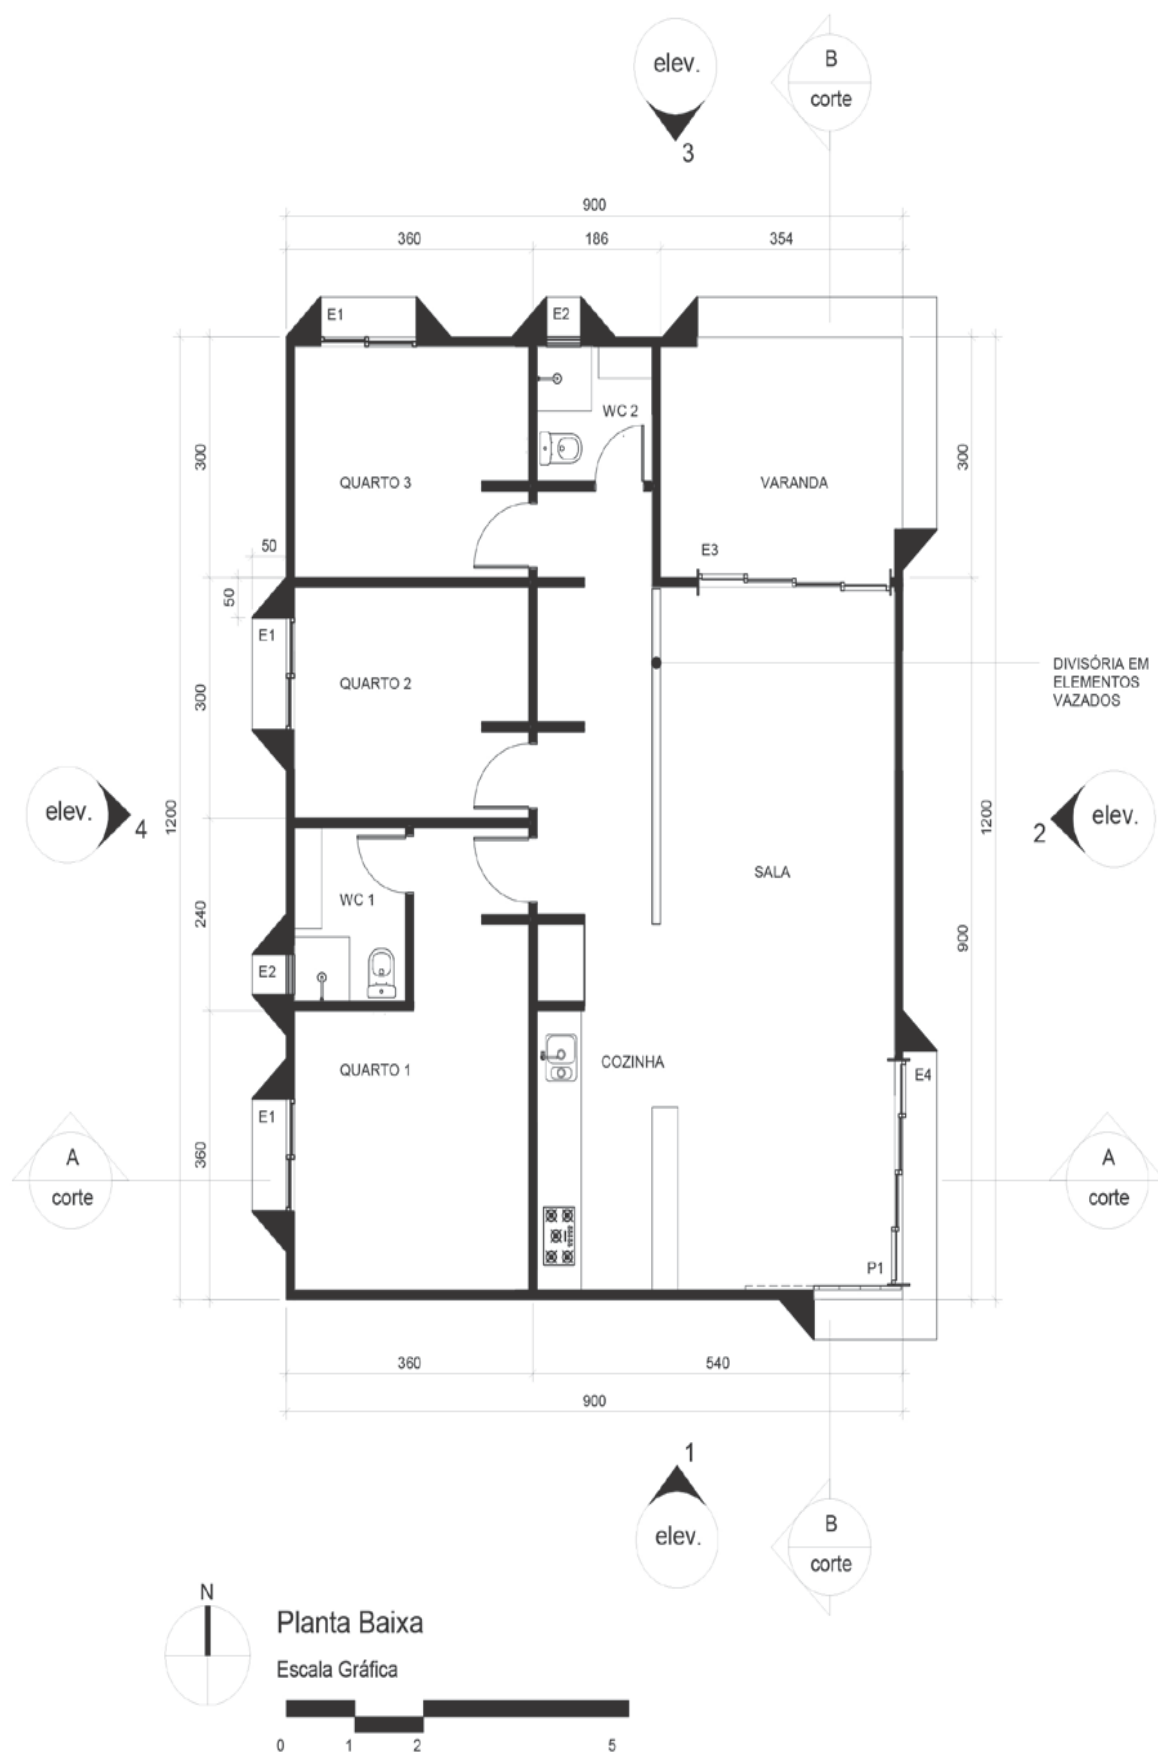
Planta baixa da casa zero (Sudbrack, 2017)
